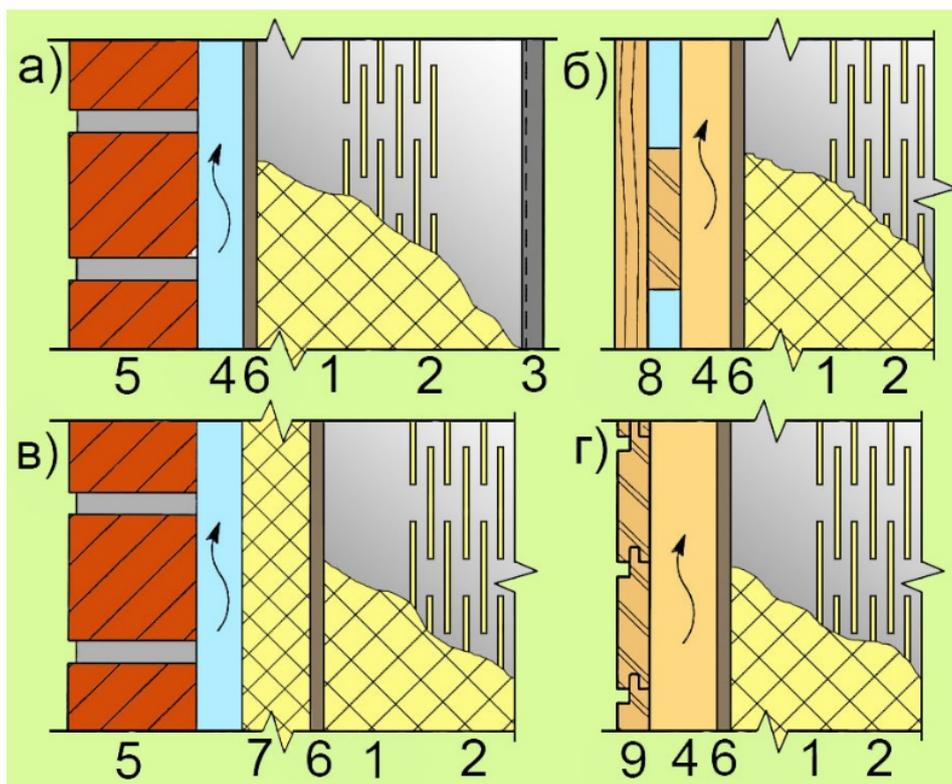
Четыре варианта наружной стены с каркасом из термопрофилей: с наружной стенкой из облицовочного кирпича (а, в) и с экраном из досок (б, г); 1 – эффективный утеплитель; 2 – термопрофиль; 3 – пароизоляция и внутренняя облицовка; 4 – вентилируемый воздушный зазор; 5 – кладка из облицовочного кирпича, б – ветрозащитная облицовка; 7 – ветрозащитный утеплитель с кашированной внешней поверхностью; 8 – облицовка из вертикально расположенных досок (крепится к горизонтальной обрешетке); 9 – обрешетка из горизонтально расположенных досок (крепится к вертикальной обрешетке)
